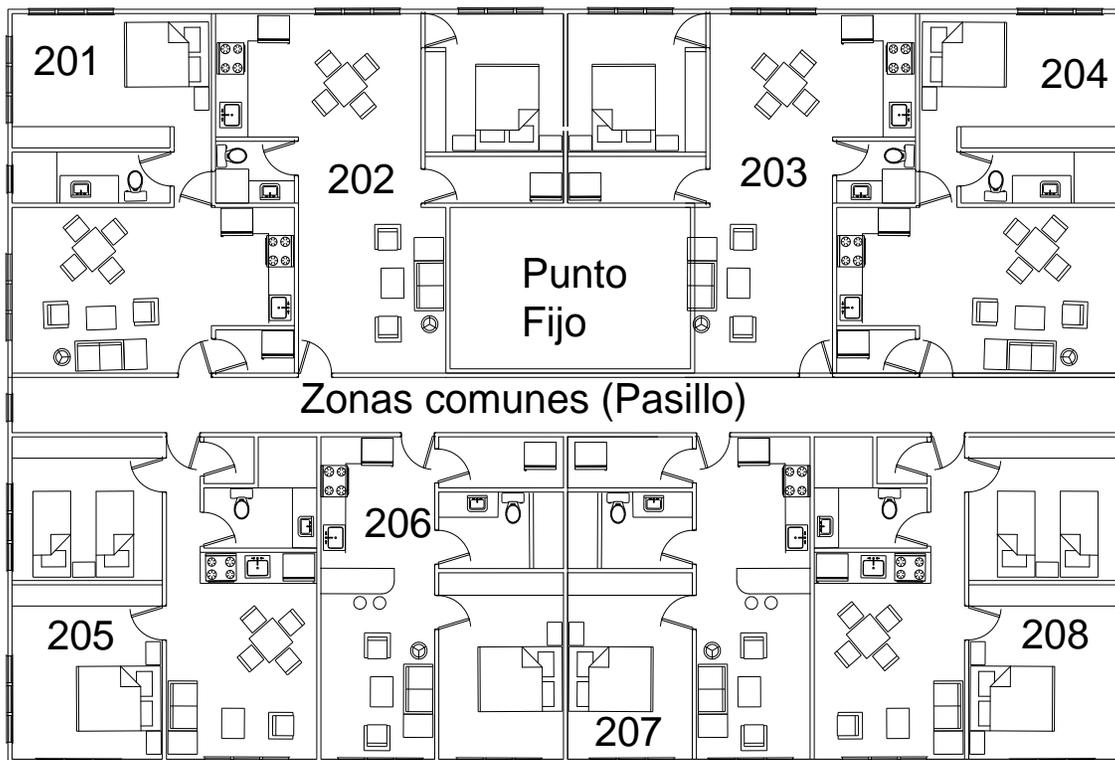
Vista en planta de un nivel tipo de apartamentos.
